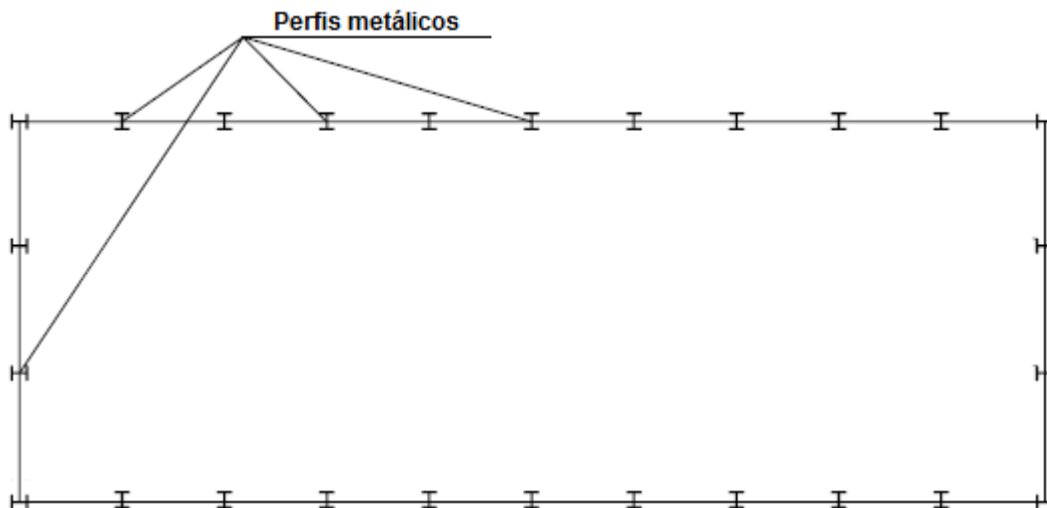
Esquema em planta representativo da colocação dos perfis ao longo do perímetro da escavação [45]
